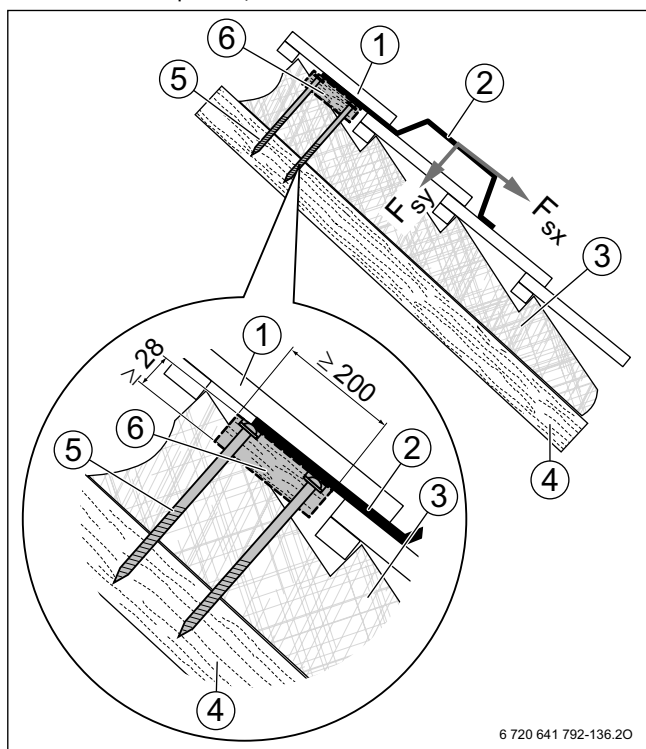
Установка по месту монтажа за счёт заказчика дополнительных деревянных брусков, к которым привинчиваются специальные кровельные крючки для крепления монтажных комплектов поверх кровли при производстве монтажных работ на крыше с надстропильной теплоизоляцией (размеры указаны в мм)
